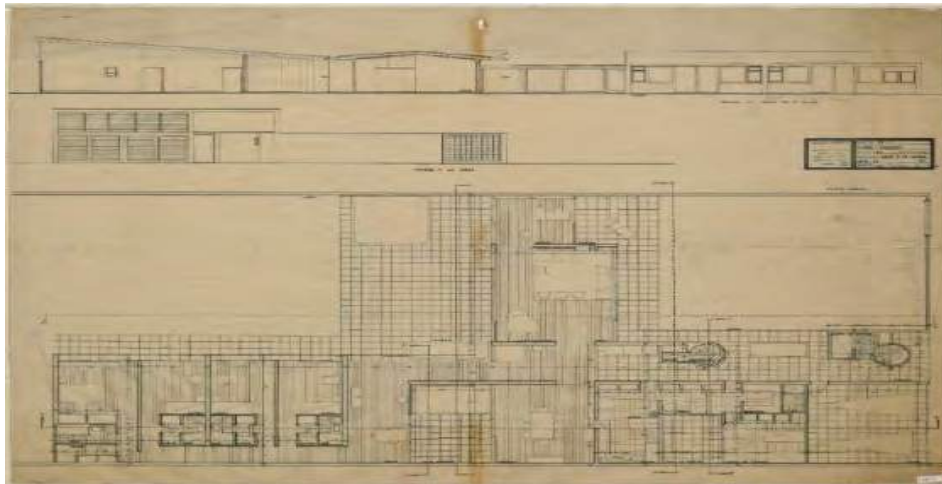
1. Planta Casa María Espinoza de Vargas
